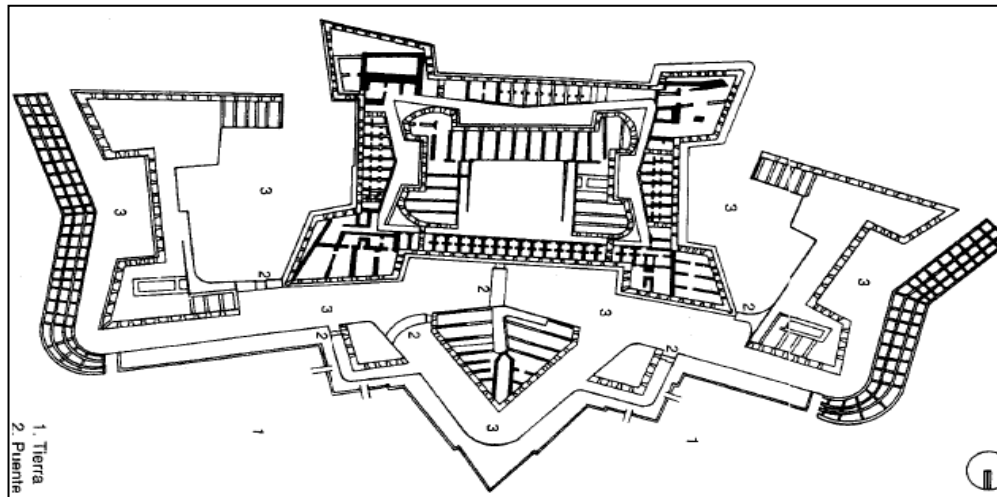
Planta arquitectónica de San Juan de Ulúa, 1977
